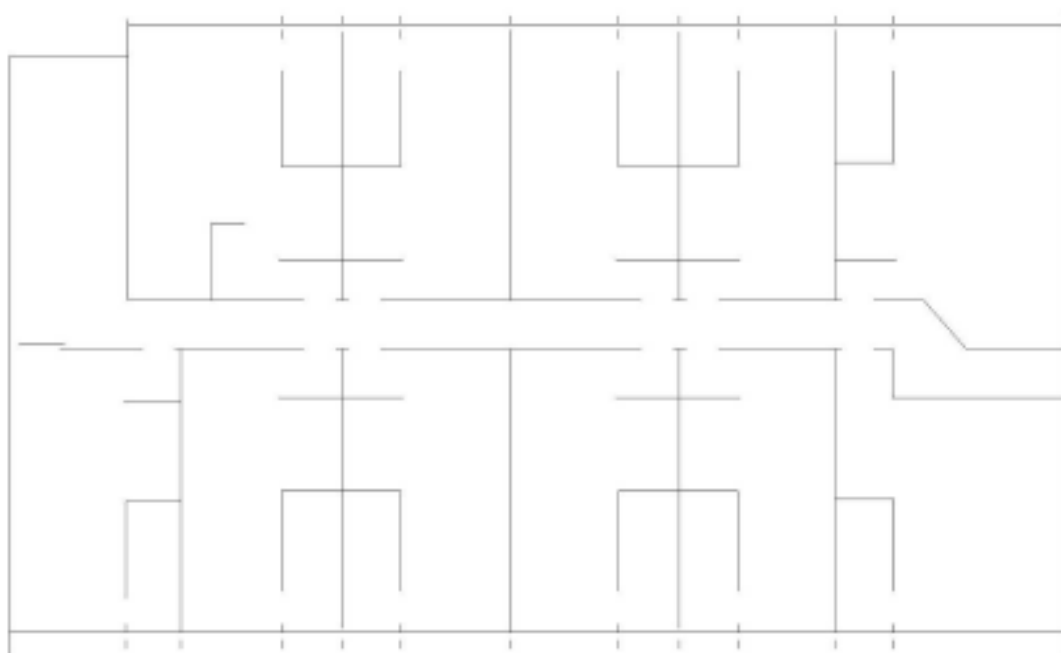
Planta baixa do décimo terceiro ao décimo sexto pavimento alterada para linhas
